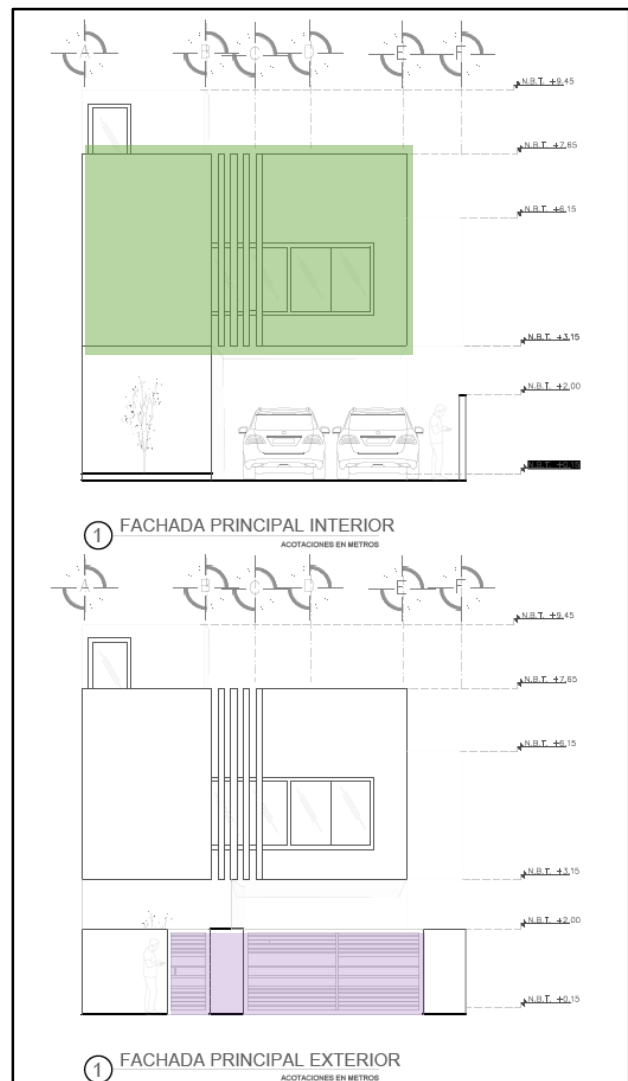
Plano arquitectónico Fachada Principal modificaciones. Elaboración propia. (YPHC 2025)
